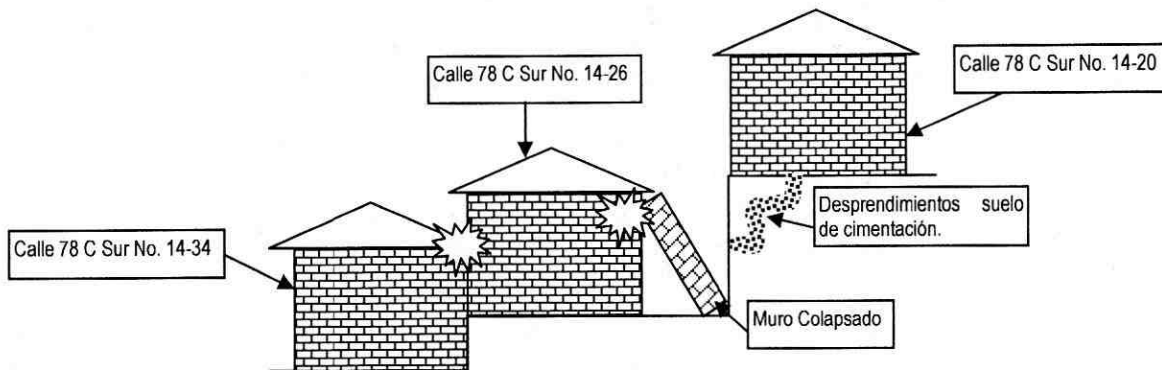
Perfil de las viviendas evaluadas y del colapso del muro en mampostería simple.
